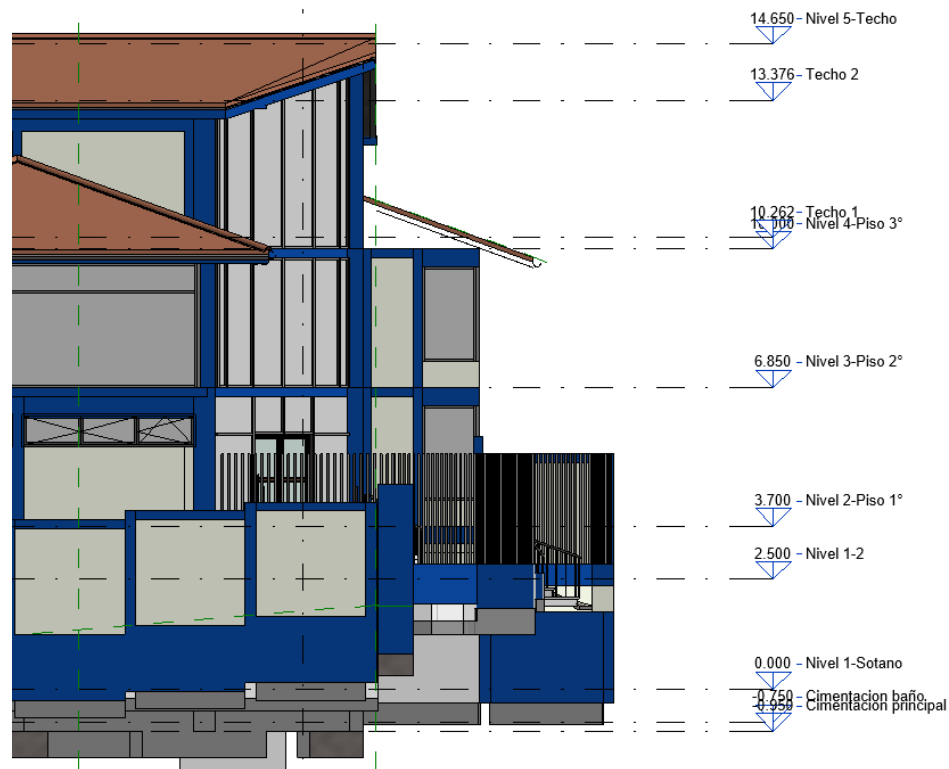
Niveles del proyecto - Arquitectura. Fuente: Autor.
